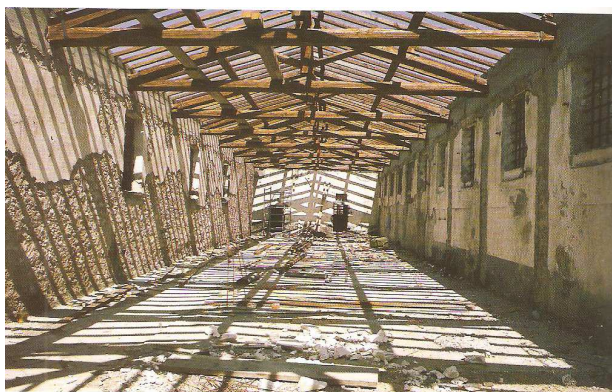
° cortile-2° piano-struttura di copertura (foto Rossini)
